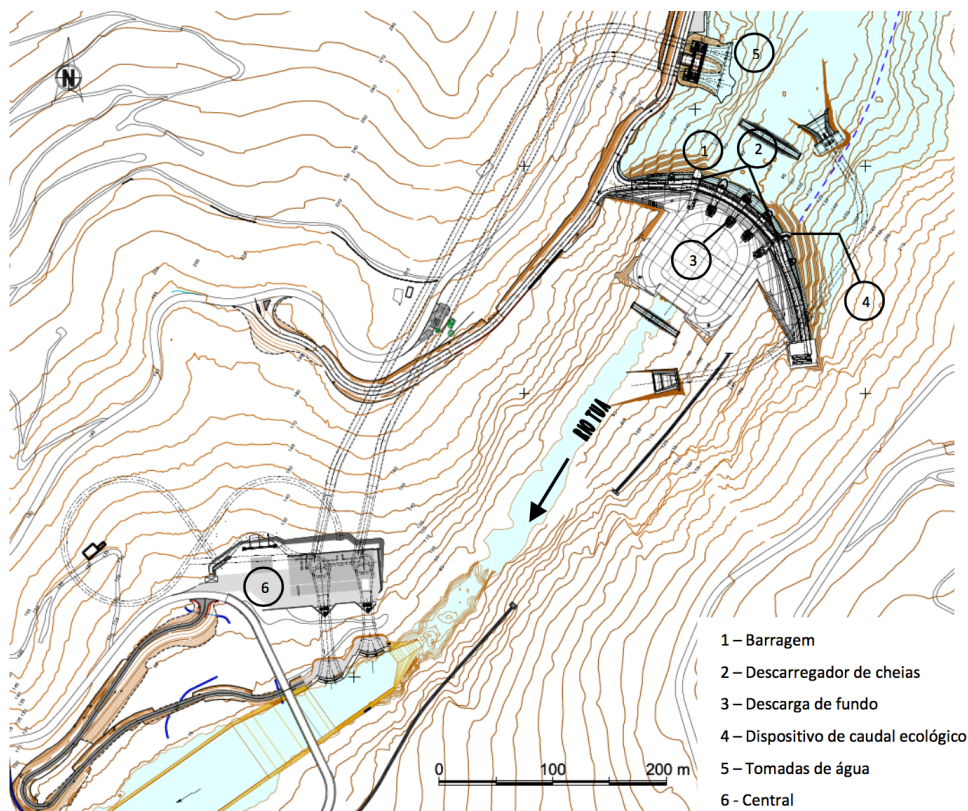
Barragem de Foz Tua. Planta geral. (Ferreira, A., *et al*, 2012).
